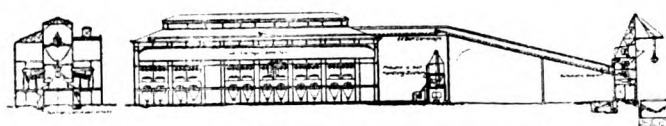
Disposizione della centrale della Havana Electric Railway, Light and Power Co.
